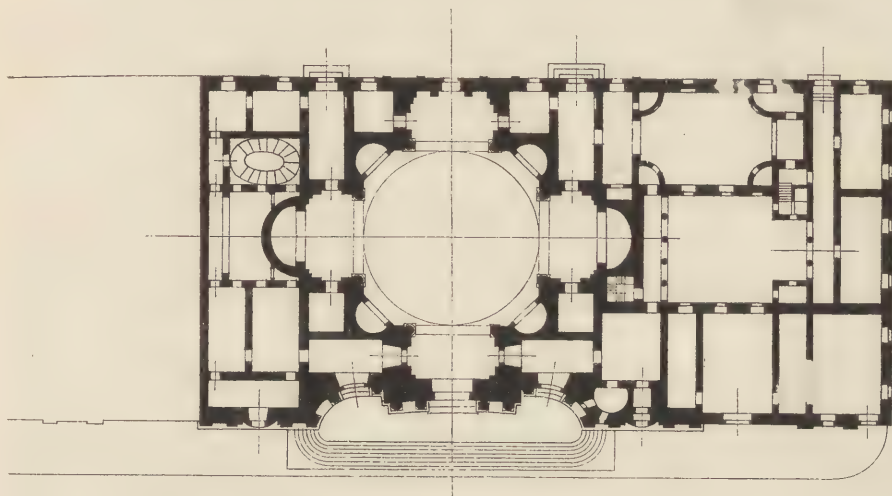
St. Agnese zu Rom. Grundriss.
